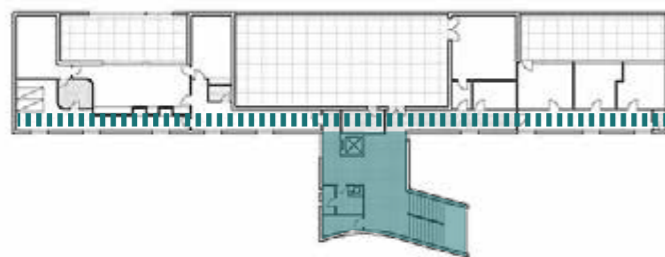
Planta del Pabellón Suizo, Arq. Le Corbusier
